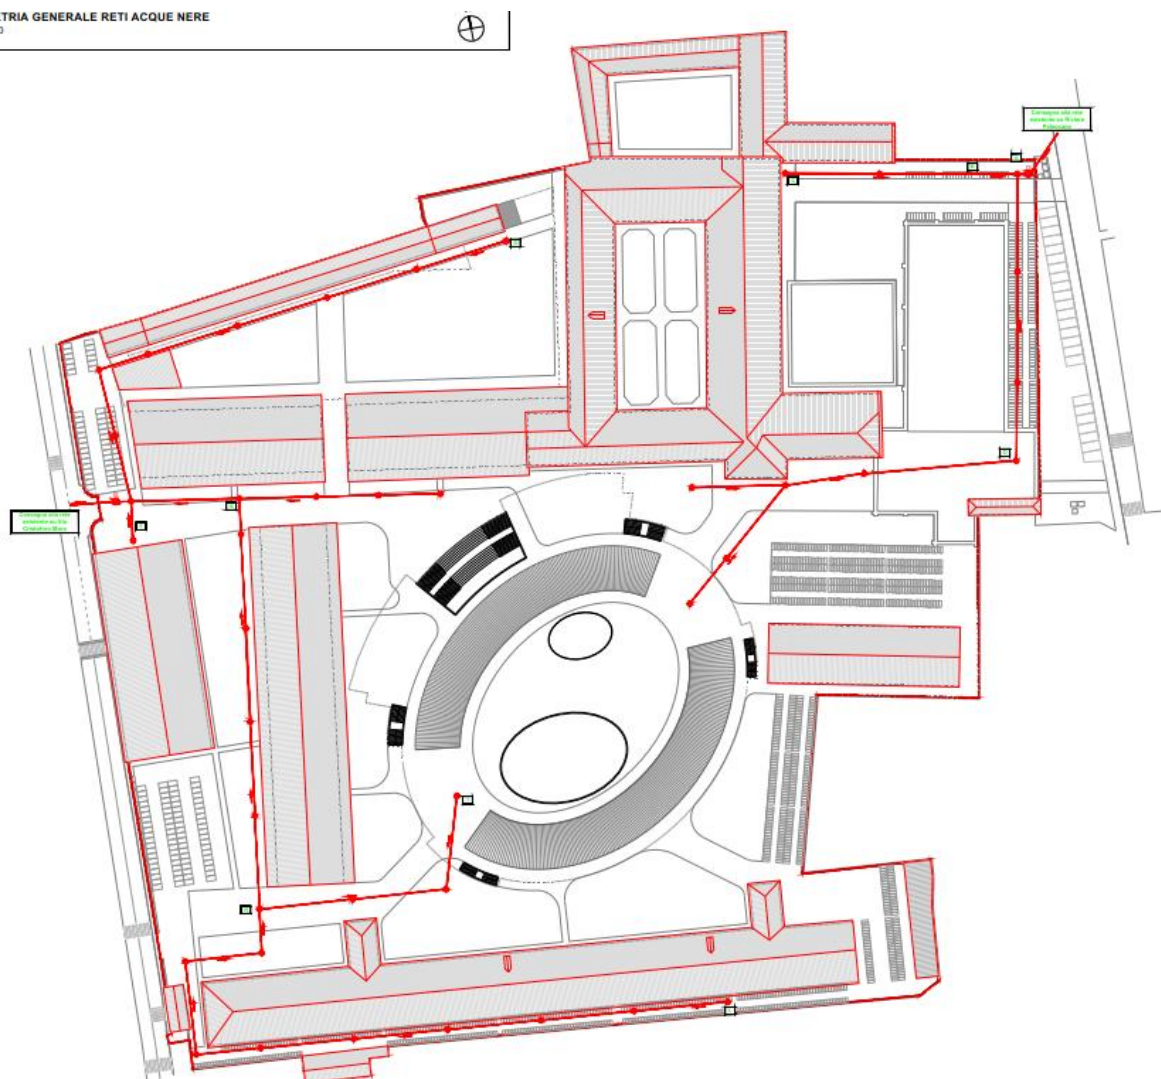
Planimetria di Progetto Rete delle Acque Nere
